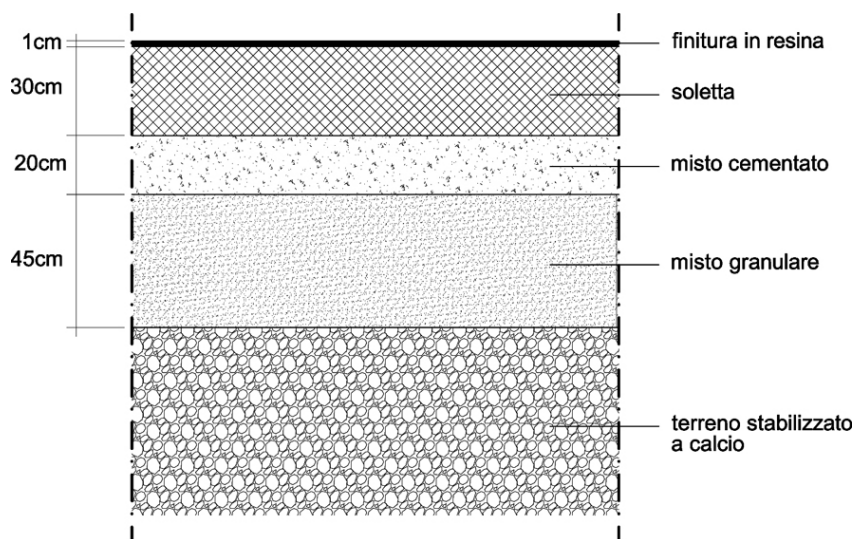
Stratigrafia pavimentazione Hangar Bay
